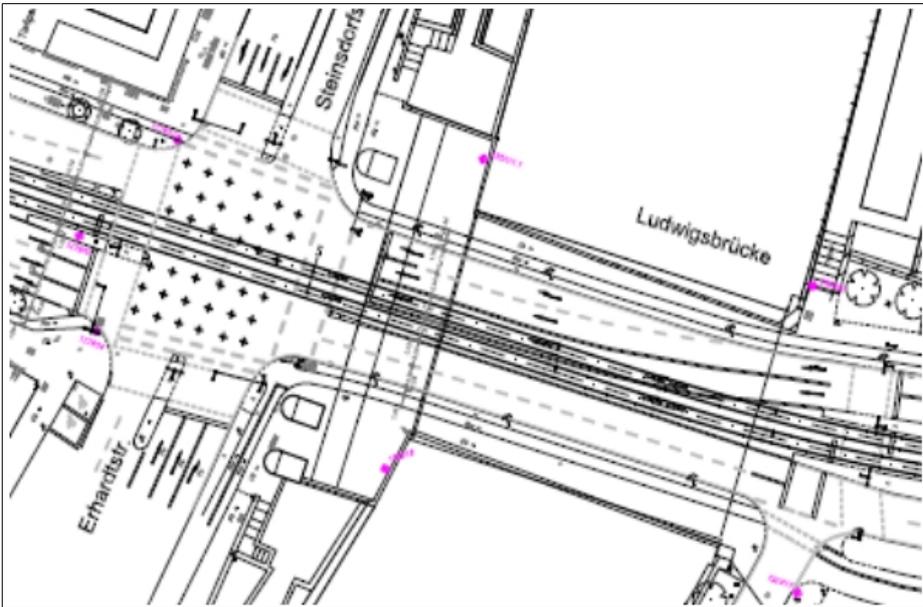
Verkehrsführung Bestand am Knoten Zweibrückenstraße / Erhardtstraße / Steinsdorfstraße
